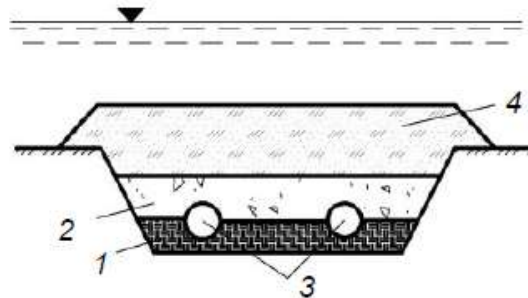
Укріплення дна і траншеї з самопливними лініями: 1 – футирівка (підкладання) з хмизових фашин, які забезпечують пружність і якісне зчеплення труб з основою; 2 – насип зі щебеню; 3 – самопливні лінії; 4 – насип з каміння або залізобетонні плити
